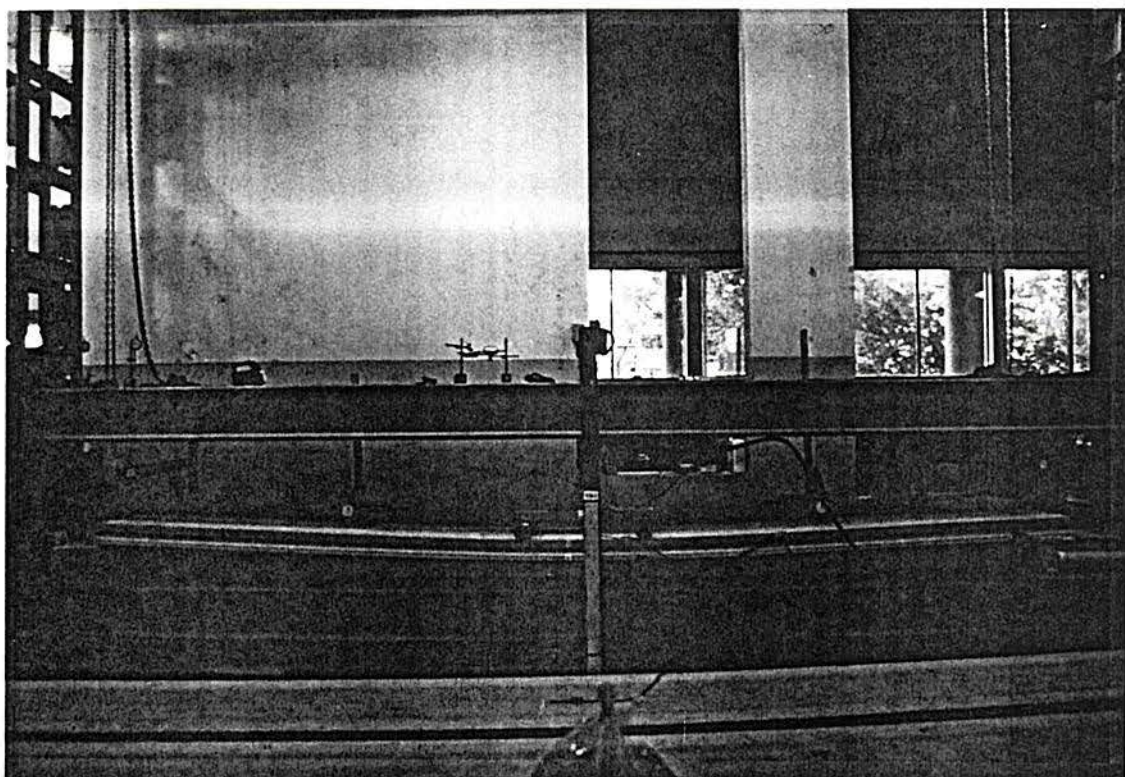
Vista do protótipo B1 durante o ensaio, carregamento crescente
